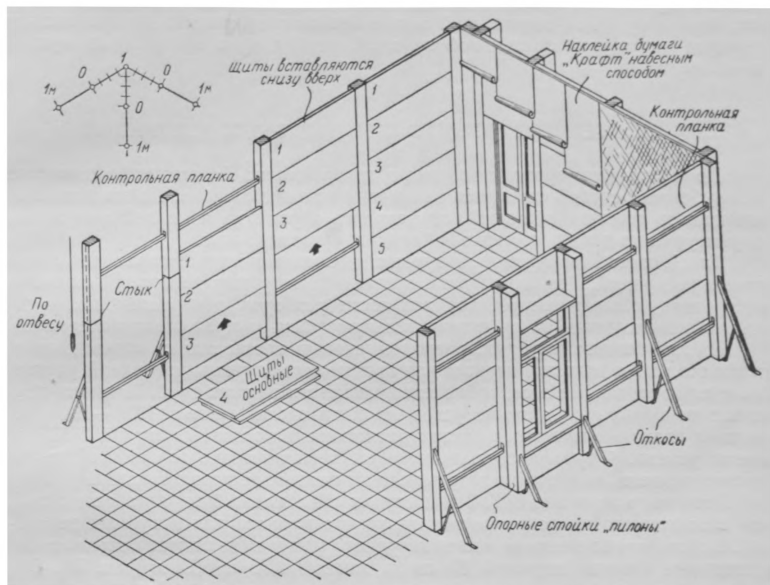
Примерная схема сборки прямоугольной в плане декорации из стенового фундуза новой каркасно-щитовой системы «Ленфильм»
